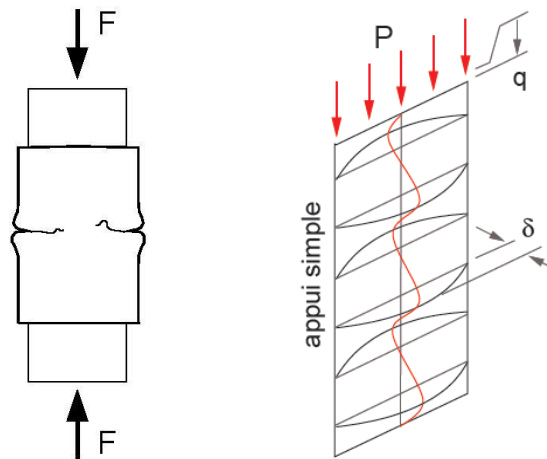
Structures en compression : poutre massive (à gauche) et plaque élancée (à droite).
